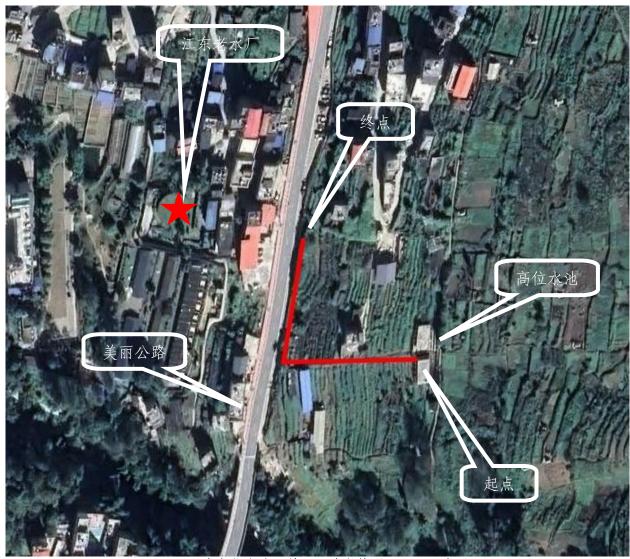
江东高位水池至美丽公路段管网工程平面布置图
